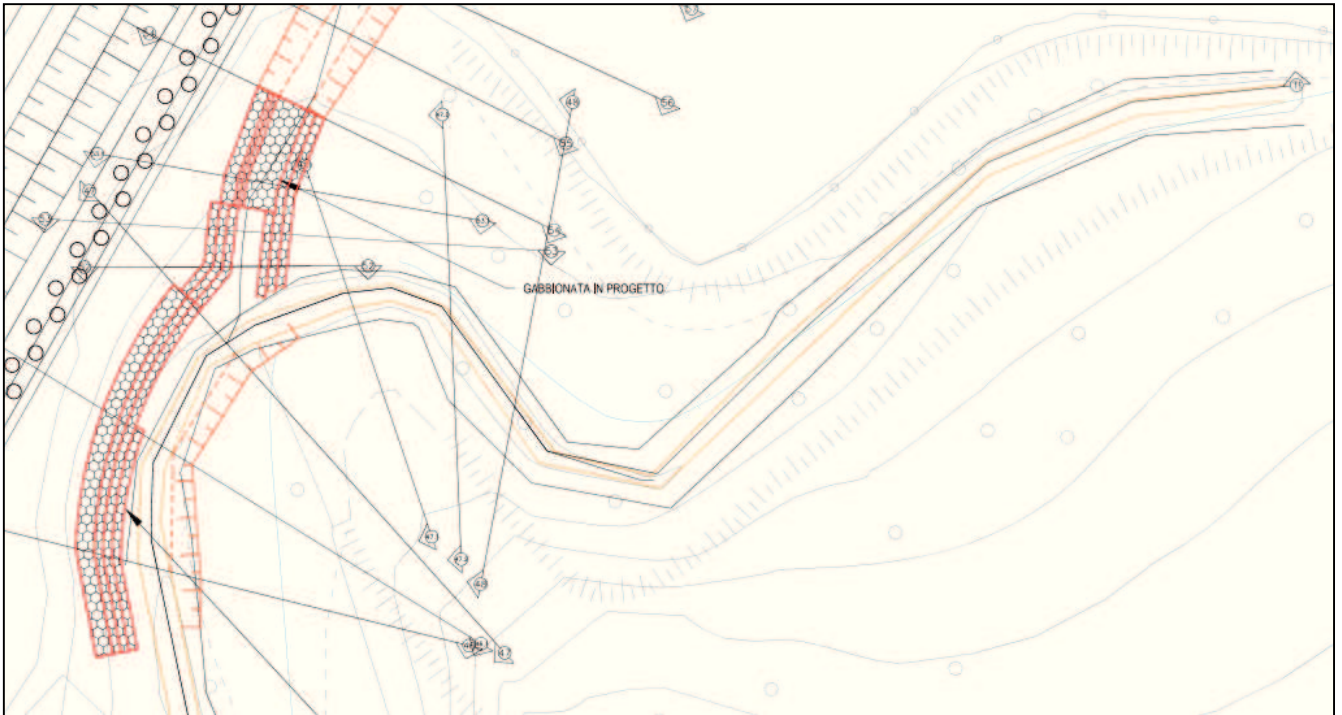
Stralcio planimetria interventi in progetto fosso 3.
